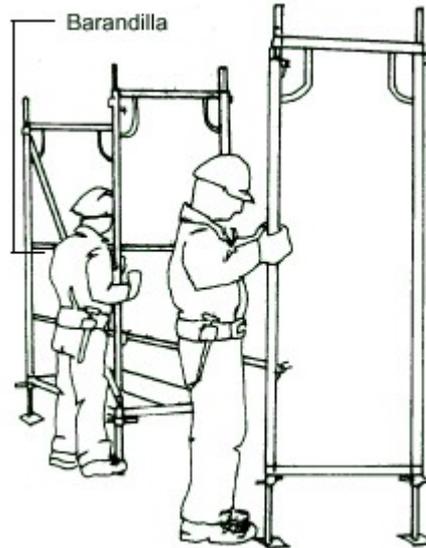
Colocación de las barandillas y el encadenamiento del andamio
